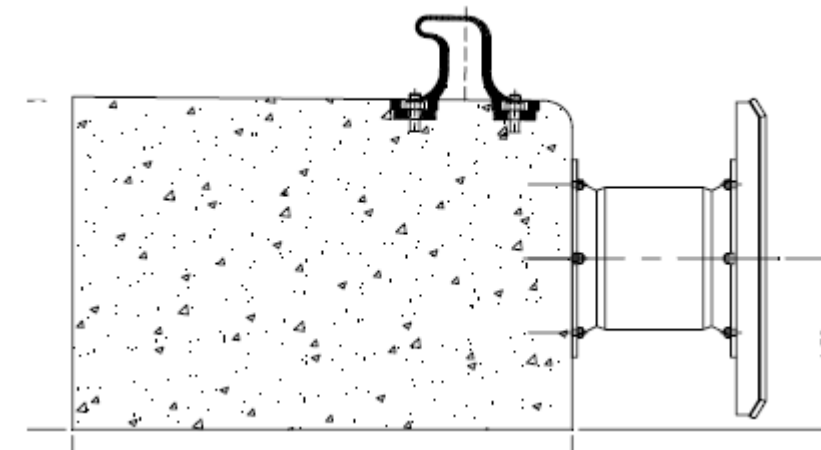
Sección de la Viga cantil con defensa y bolardo
